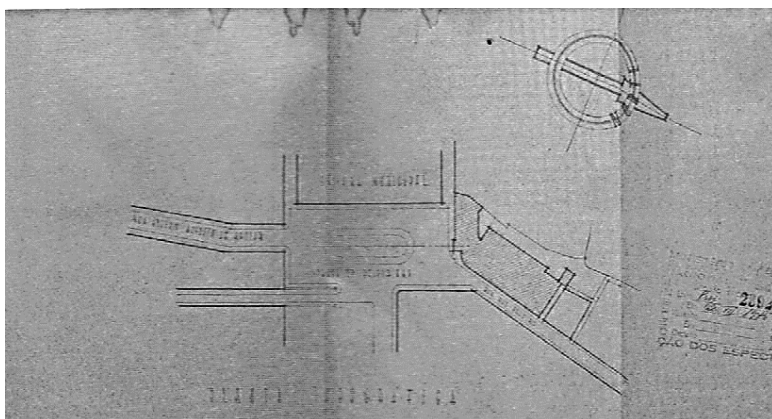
Planta de implantação do Teatro Cine da Covilhã para o projecto de licenciamento em 1954.
